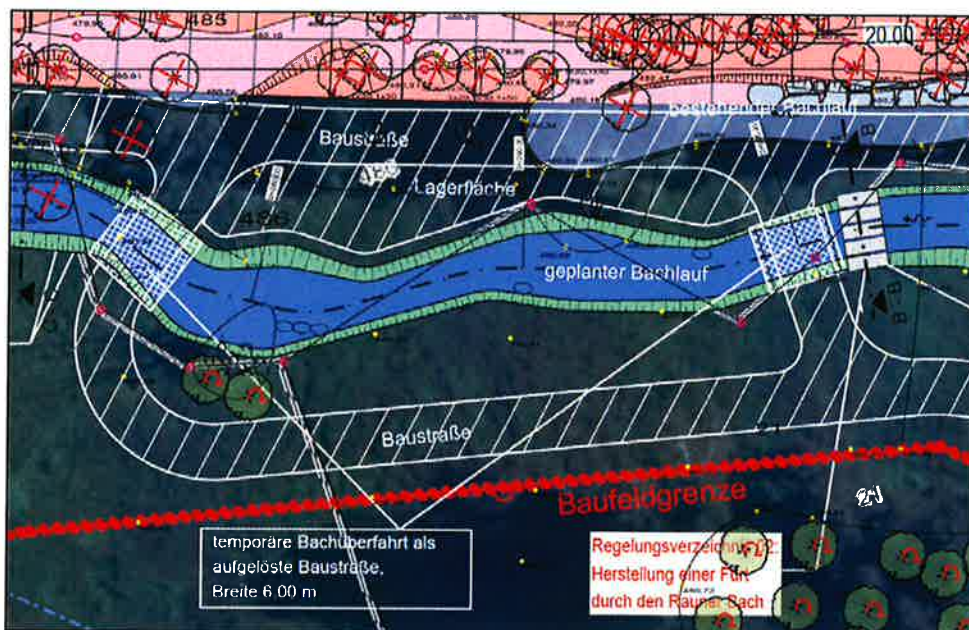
Ausschnitt Lageplan Baubereich mit 2 Gewässerüberfahrten (weiß schraffiert) (aus Anlage 5.1, [LAS-21])
